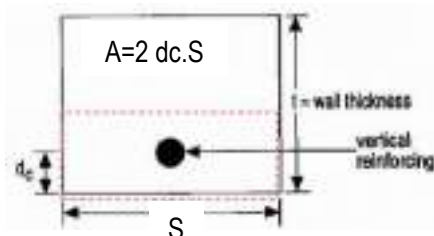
Área efectiva de tensión del concreto para el cálculo de Z (Project, 2006)
